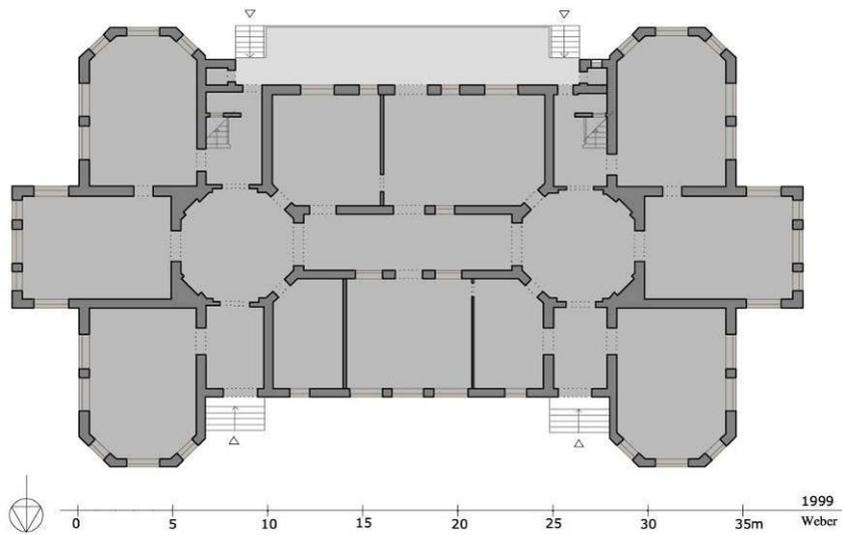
Lehrerausbildungsinstitut [54], Grundriss EG
